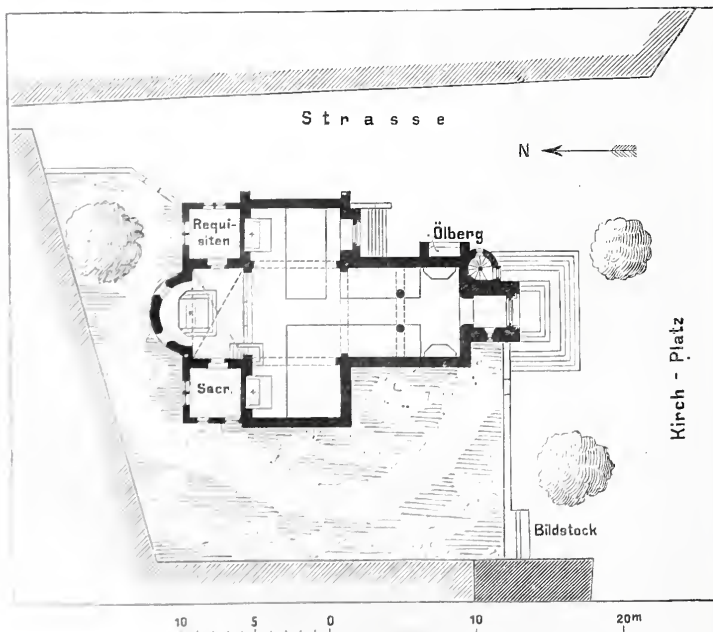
Lageplan und Grundriss zu ebener Erde.
